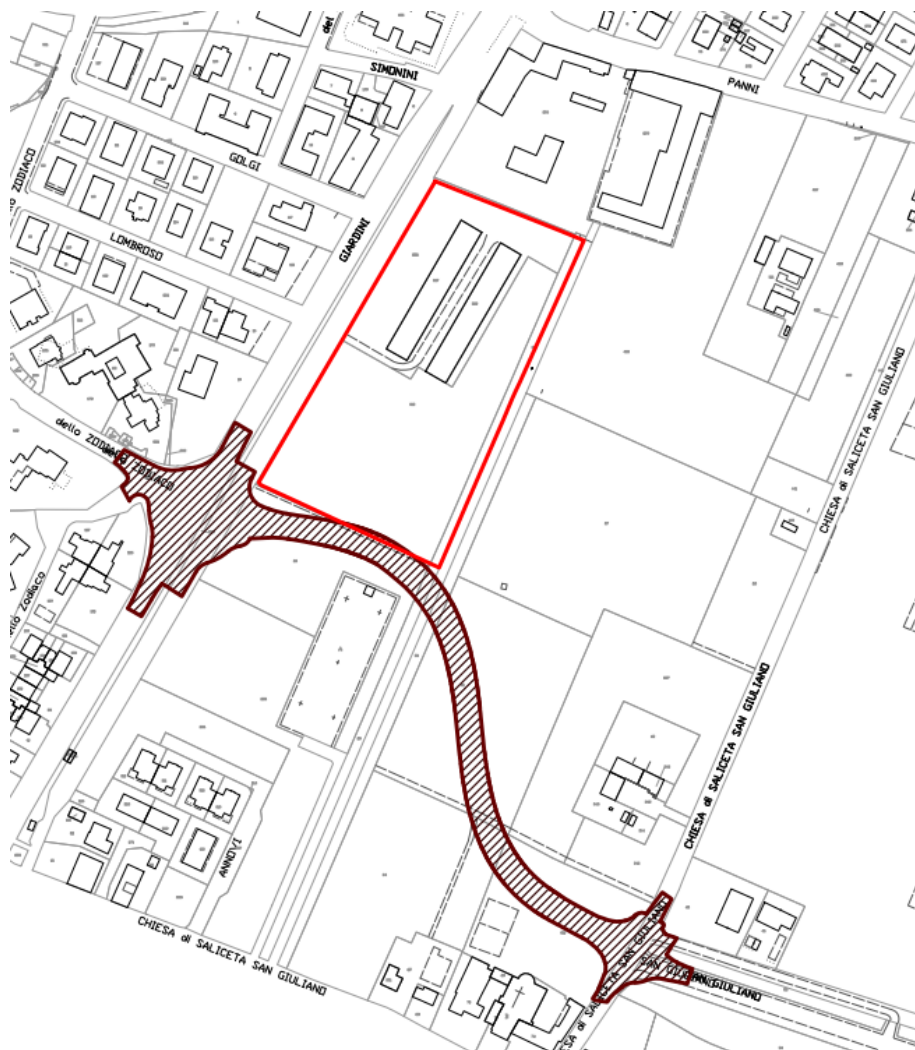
Planimetria dell'intervento di realizzazione della nuova infrastruttura stradale (tratteggio a linee).
